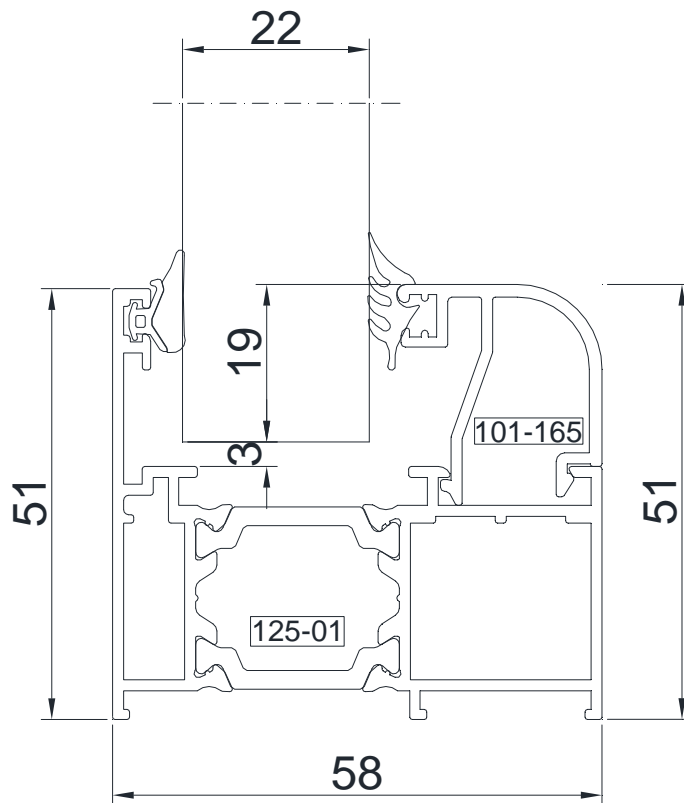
Profilquerschnitt – Probekörper 01 – Blendrahmen
